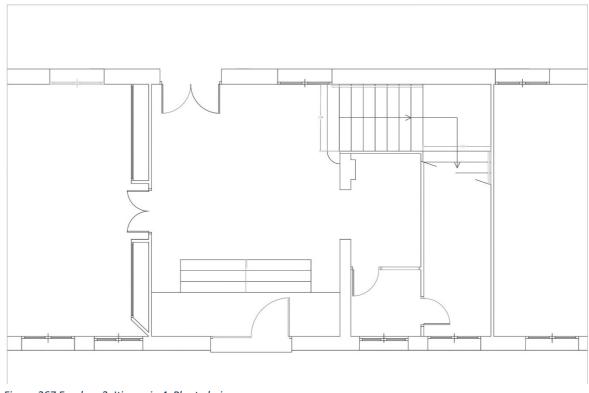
Escalera 3, Itinerario 4, Planta baja.
